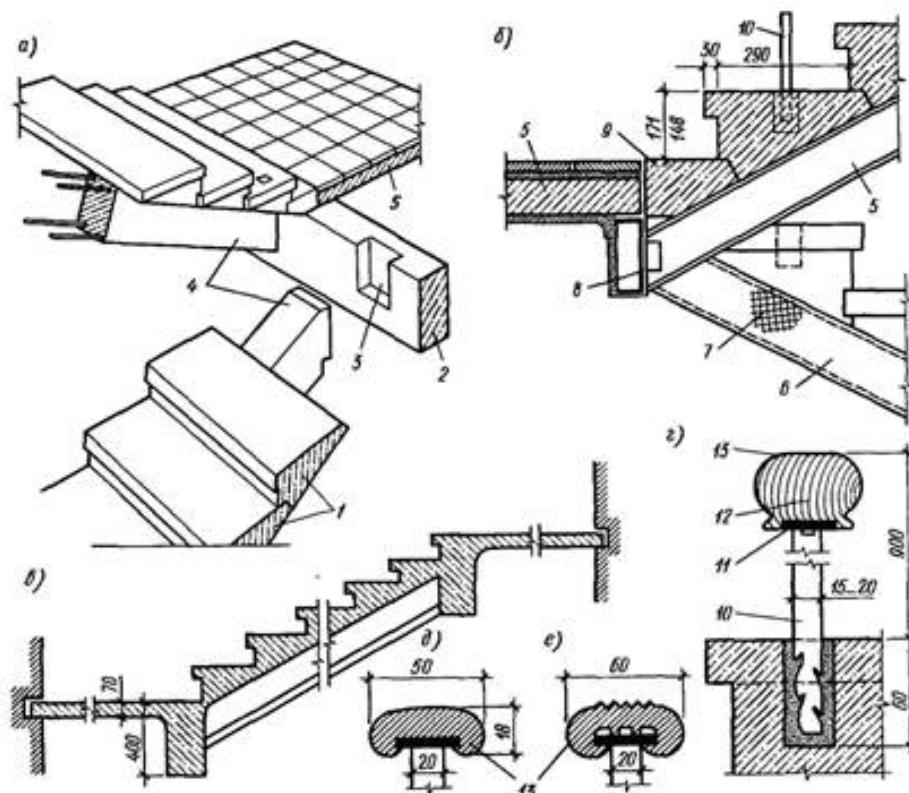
Конструкции лестниц: а – сборная из железобетонных мелкоразмерных элементов, б – по стальным косоурам, в – монолитная железобетонная. Узлы: г – заделка стоек и крепление деревянного поручня, д, е – крепление пластмассовых поручней: 1 – ступени, 2 – площадочная балка, 3 – гнездо для конца косоура, 4 – косоур сборный железобетонный, 5 – плита лестничной площадки, 6 – стальной косоур, 7 – штукатурка по стальной сетке, 8 – стальная площадочная балка, 9 – фризовая ступень, 10 – стойка перил, 11 – стальная полоса, 12 – шурупы, 13 – поручень
